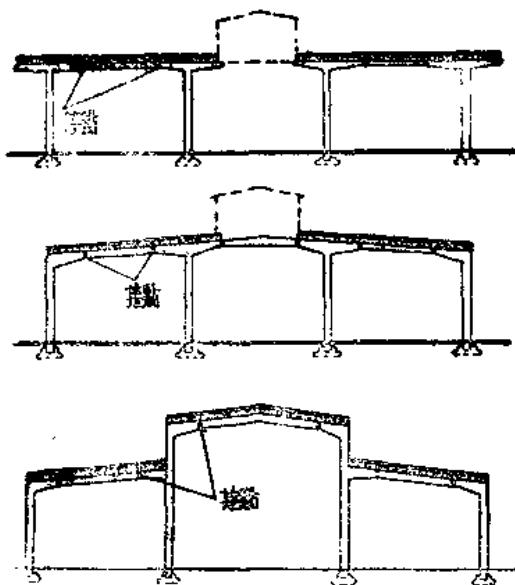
單層工業廠房中預制鋼筋混凝土框架的形式
